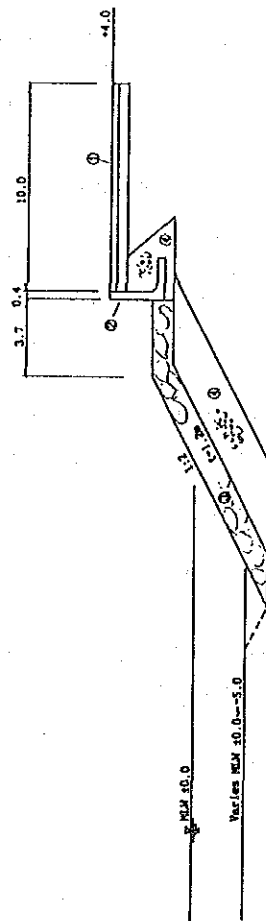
Muro de Mar : MLW +0.0 a -5.0m
